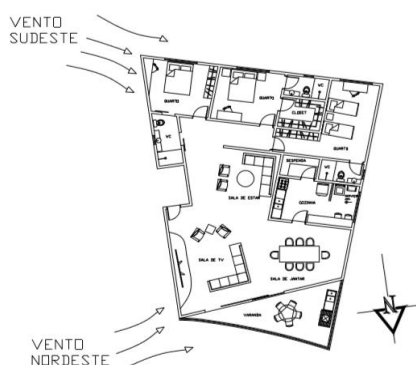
Planta baixa do apartamento tipo 1. Fonte: elaborado pelos autores.
